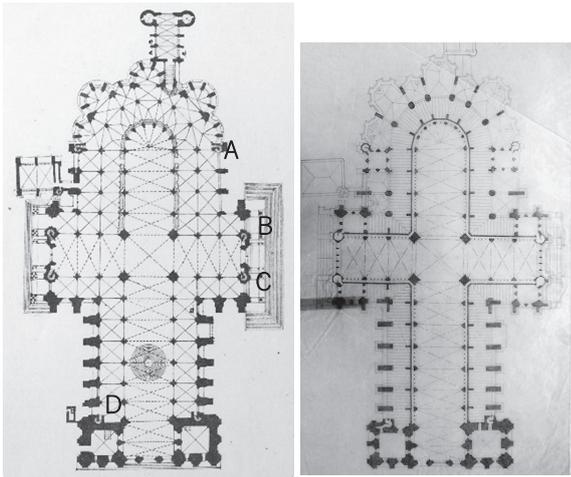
シャルトル大聖堂。地上階平面図、トリフォリウム階平面図
